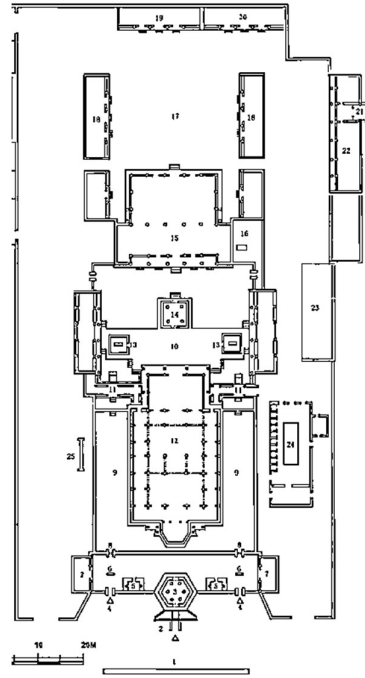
المسقط الأفقي لمسجد تشينغ تشينغ
